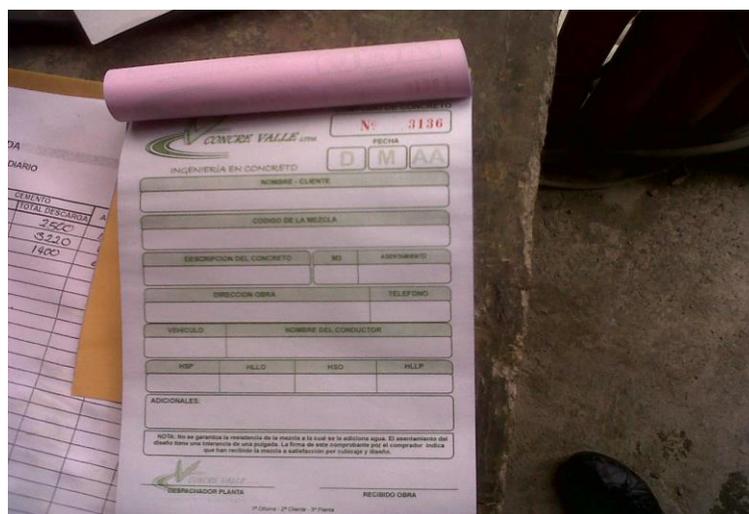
RECIBO DE DESPACHO DE CONCRETO
